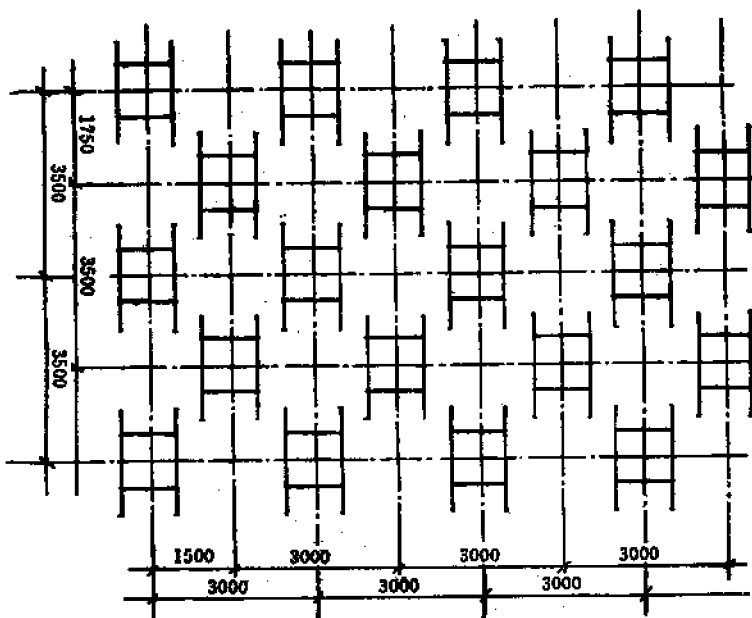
(4) 钢筋支架平面布置图(140×120)
